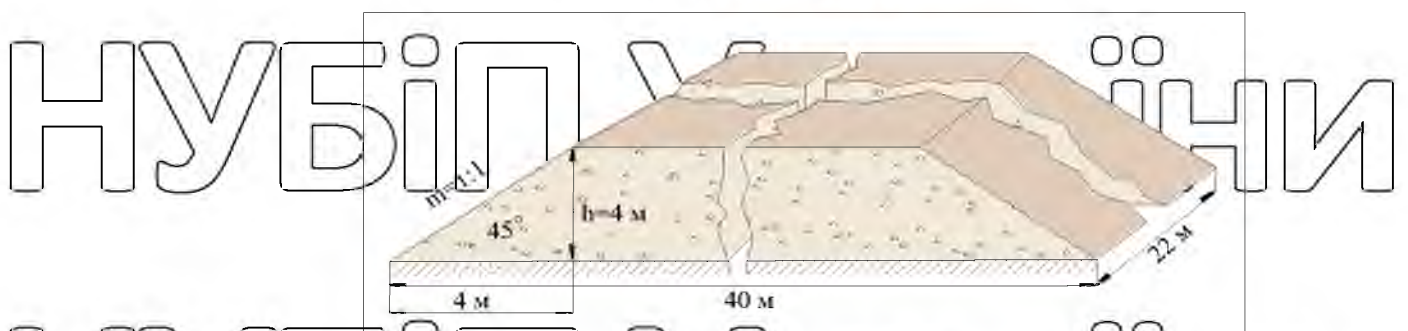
Схема поперечного перерізу тимчасового відвалу № 2 верхнього найбільш родючого шару ґрунту
